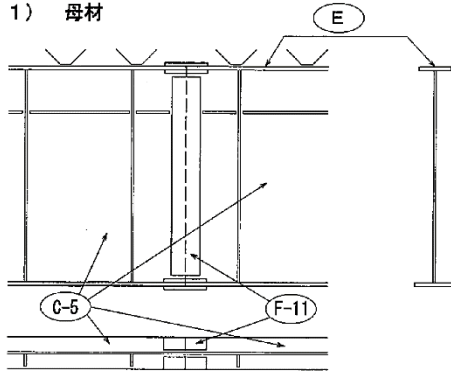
鉄筋コンクリート床版を有する I 桁の塗装区分図 (1/2)
